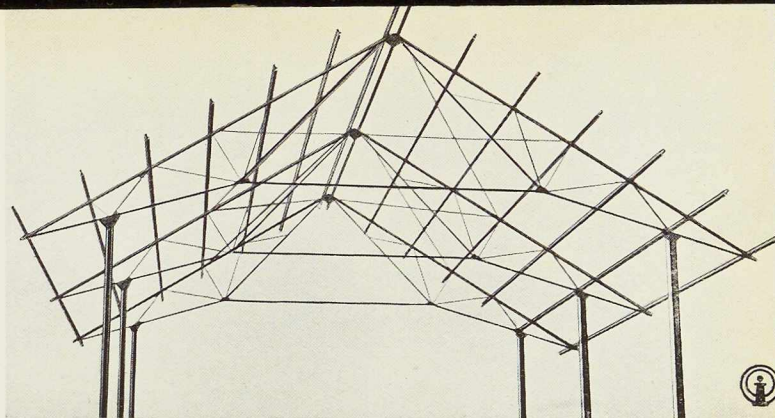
Halle de 8^m70 de portée, chaque ferme est constituée par deux demi-fermes triangulaires assemblées par soudure.
